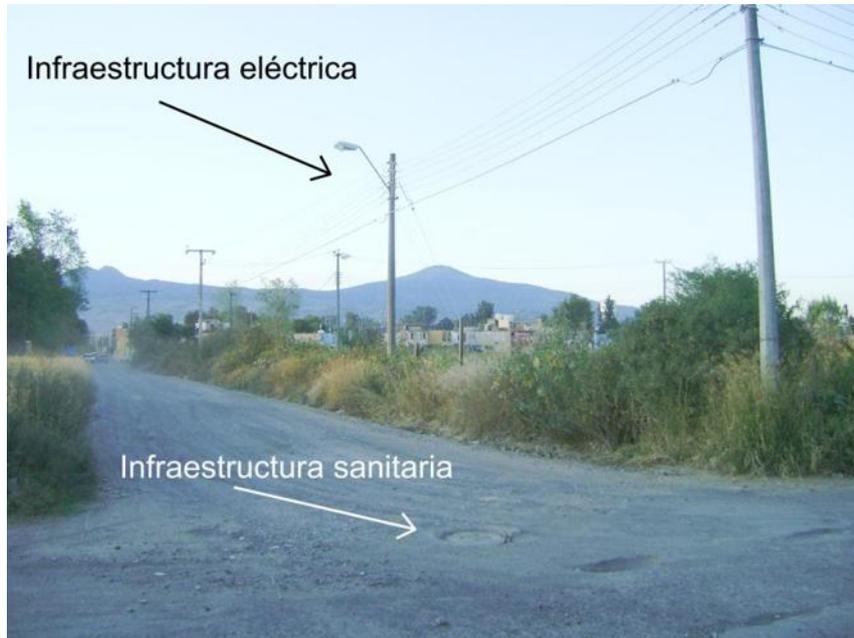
Infraestructura existente en el terreno, calle M. Ávila Camacho. Fotografía: Sajid G.
